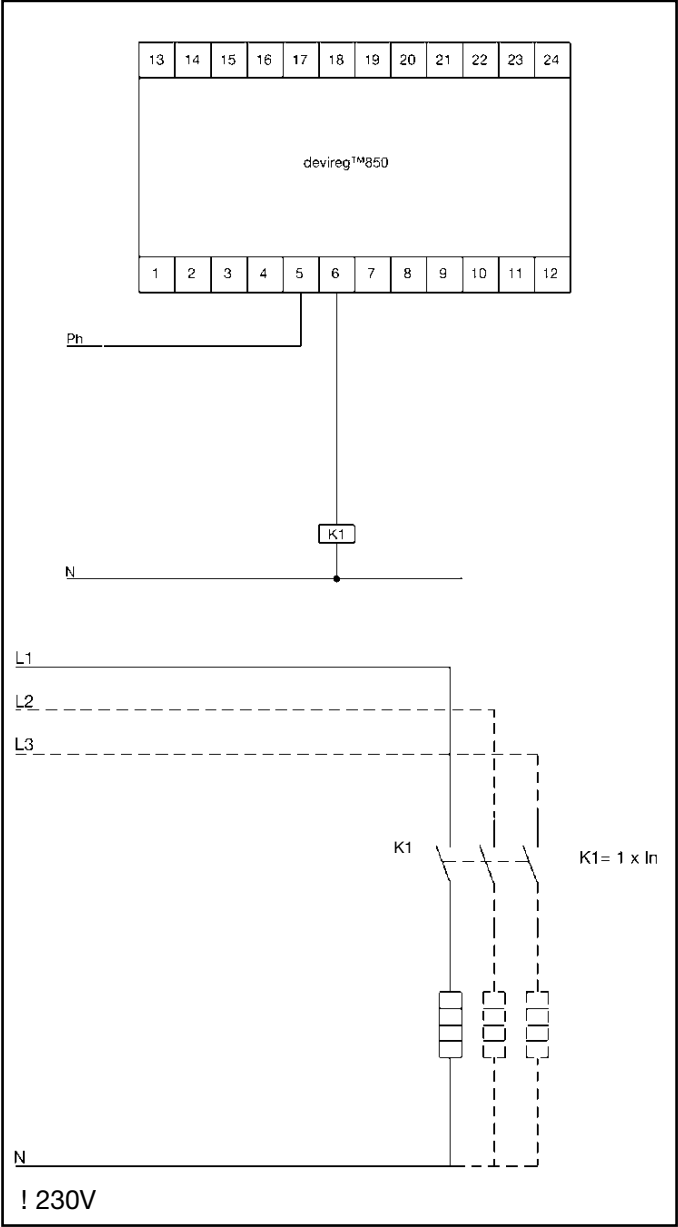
фазы, 1-3 кабеля на 230
